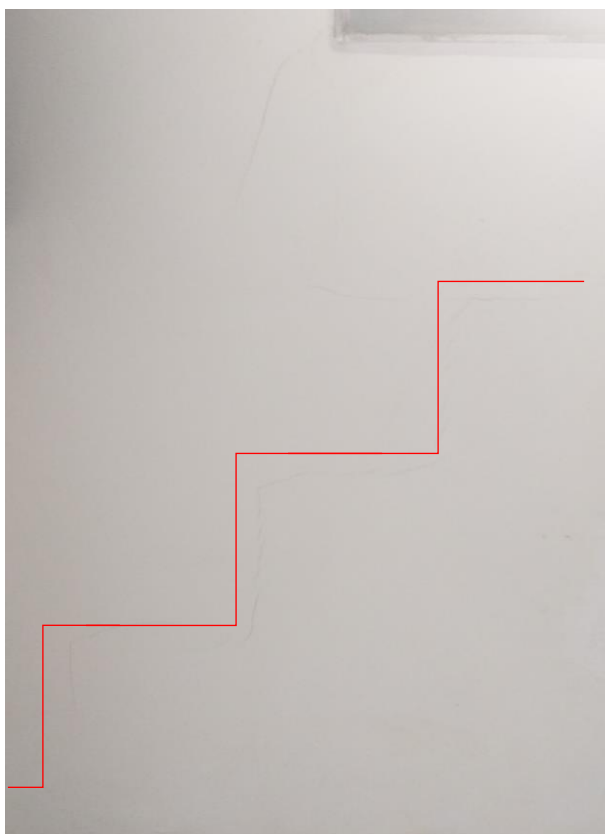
Fissura predominante da argamassa (VISTA A)
